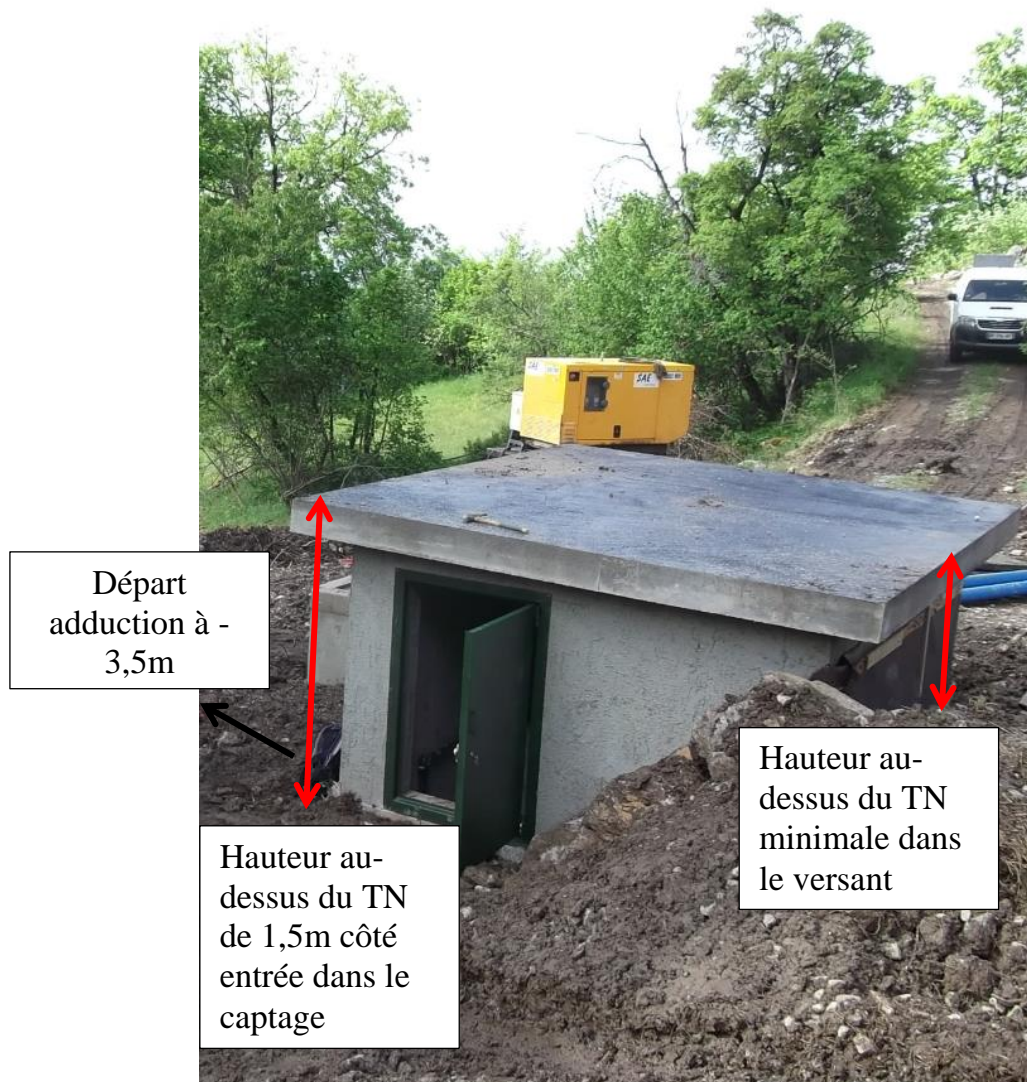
Exemple de l'ouvrage de captage de Prunières
